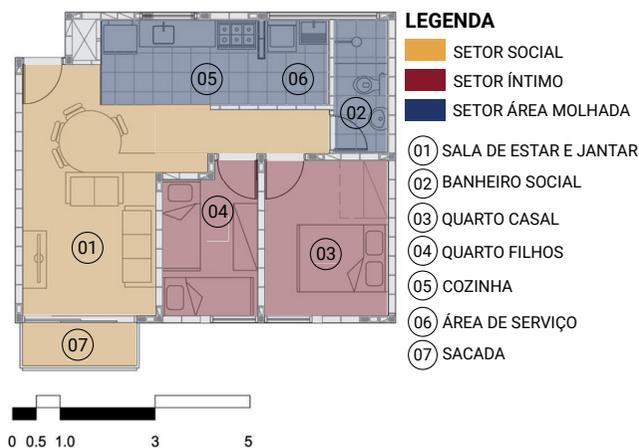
Planta baixa do apartamento tipo A. Fonte: Archdaily (2021), adaptado pela autora.
